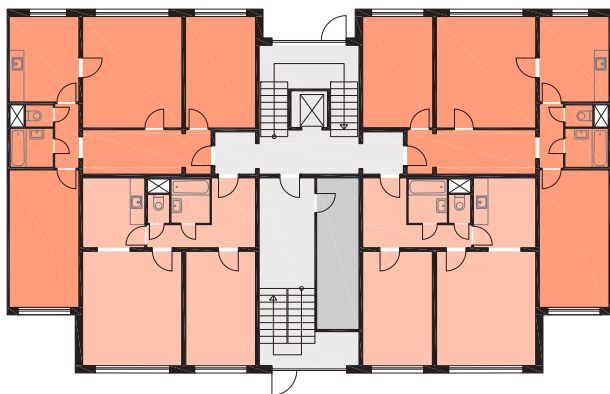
Konstrukční soustava OP 1.31 - Haviřov (Zdroj: panelaky.info)
